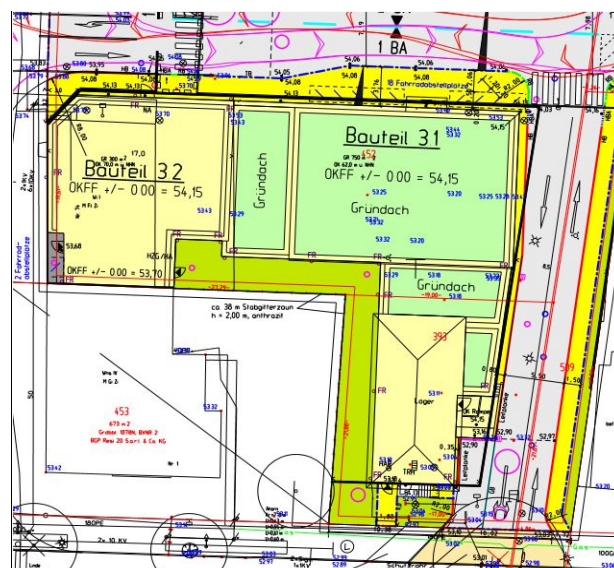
Lageplan des Baufelds mit Bauteil 3.2 und Bauteil 3.1 (Quelle: Ausschnitt Lageplan Straßenbau ITN Ing.-Büro für Tiefbau Noak)
